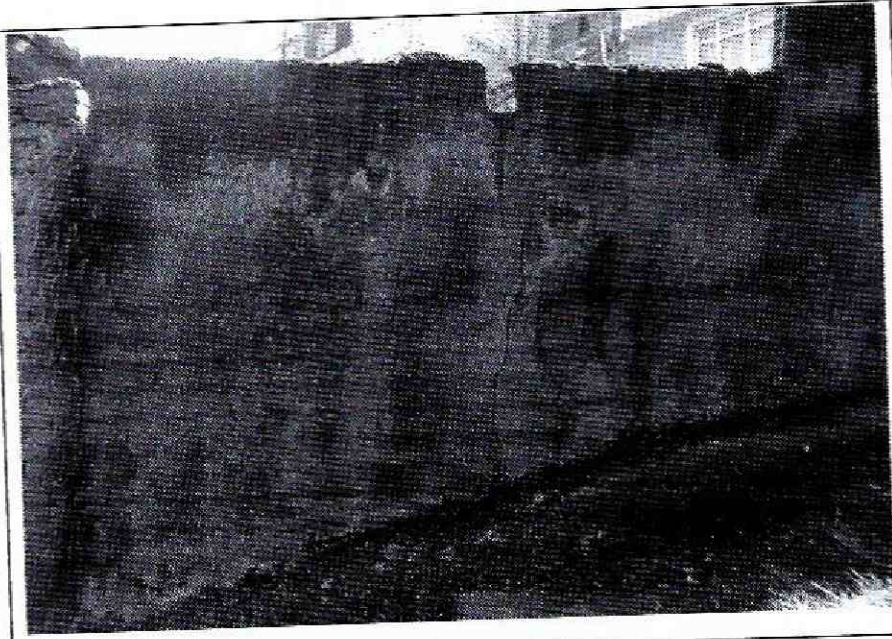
Grieta vertical en el extremo norte del muro.
